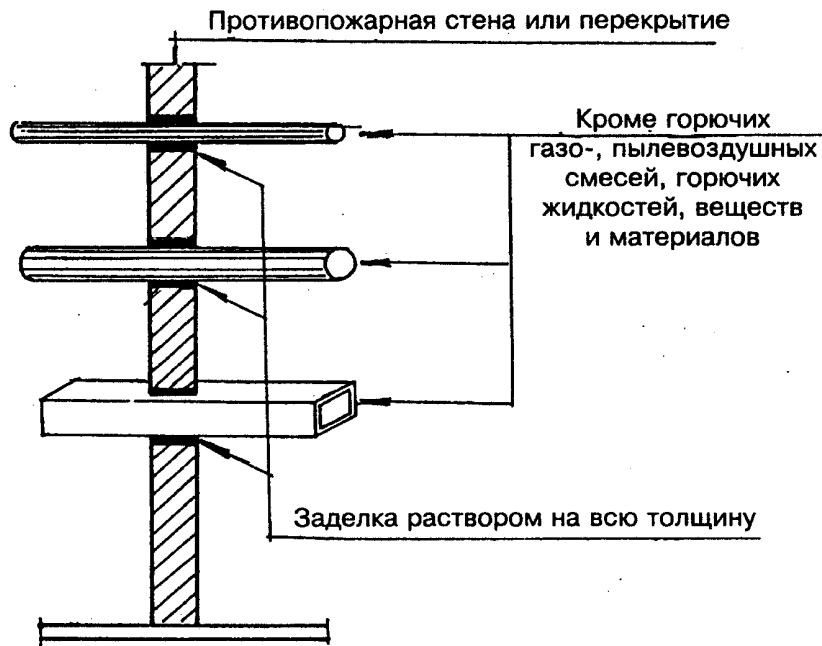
Пересечение противопожарных стен, зон и перекрытий 1-го типа каналами, шахтами, трубопроводами
